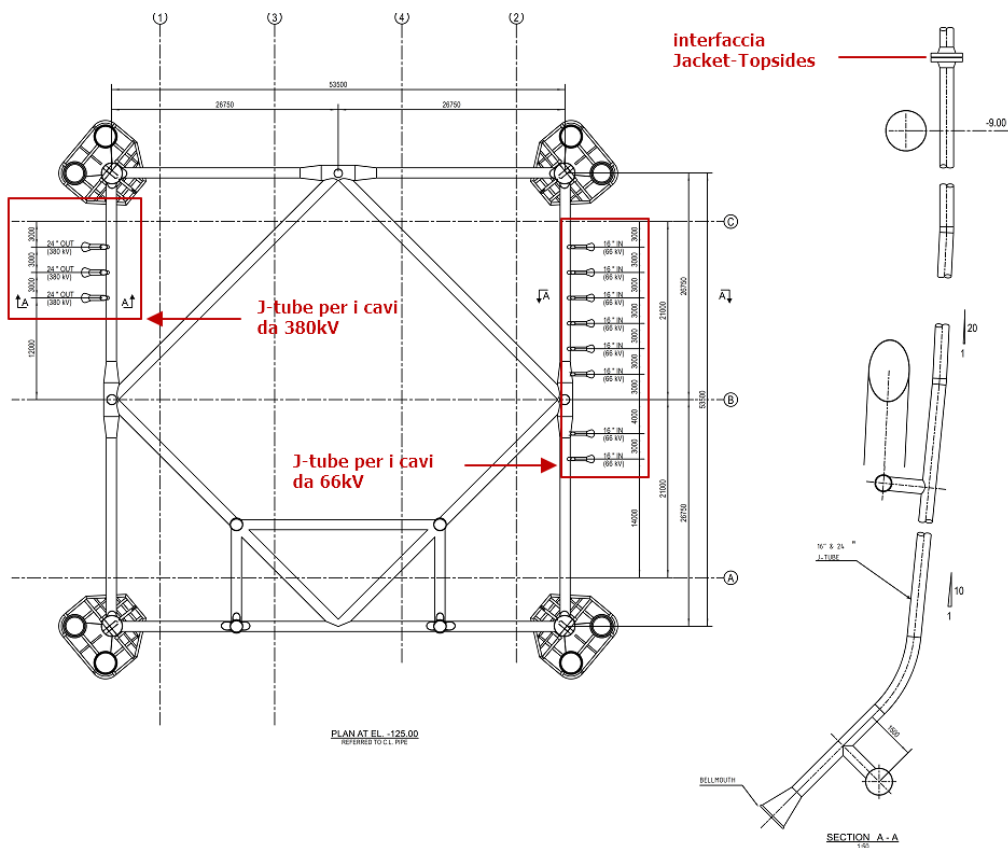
J-tubes Sottostazione 1 - vista in pianta e laterale
